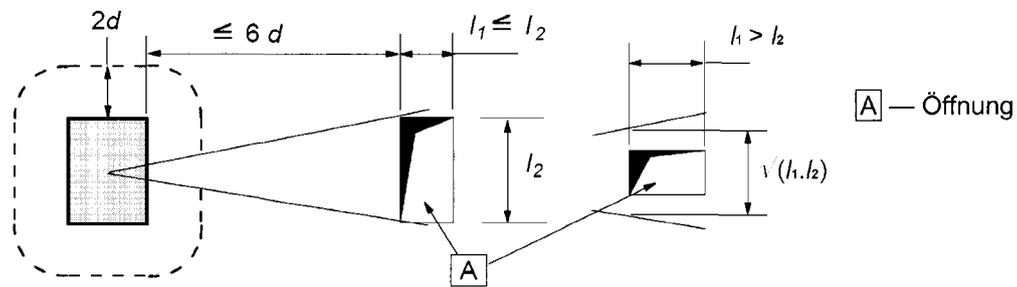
Rundschnitte in der Nähe von Öffnungen
